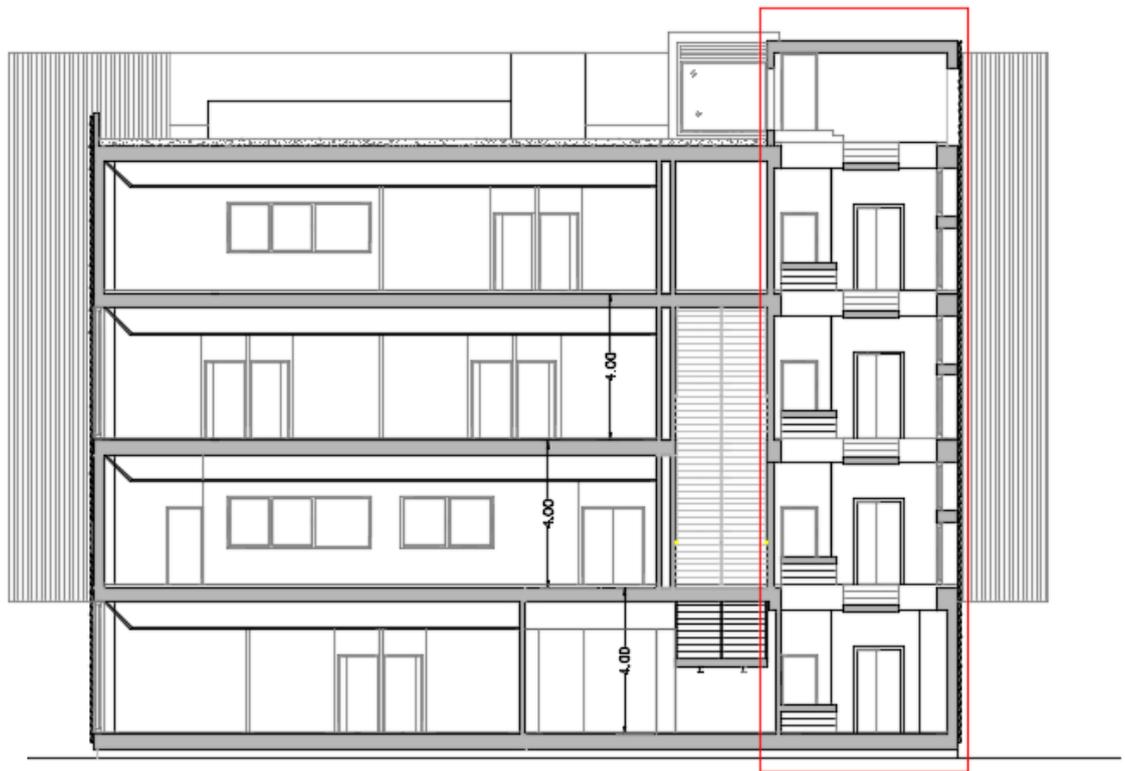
Situación escalera de emergencia. Figura extraída del plano 2 y 29
